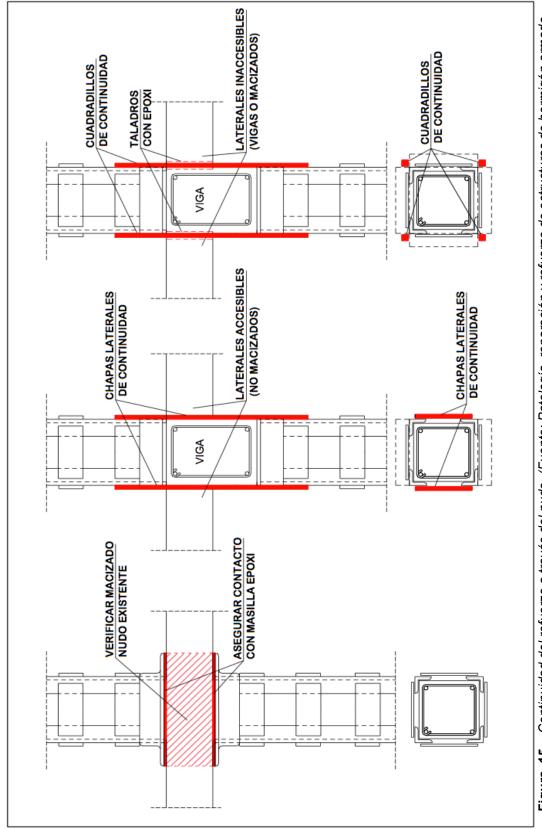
Continuidad del refuerzo a través del nudo. (Fuente: Patología, reparación y refuerzo de estructuras de hormigón armado de edificación)
